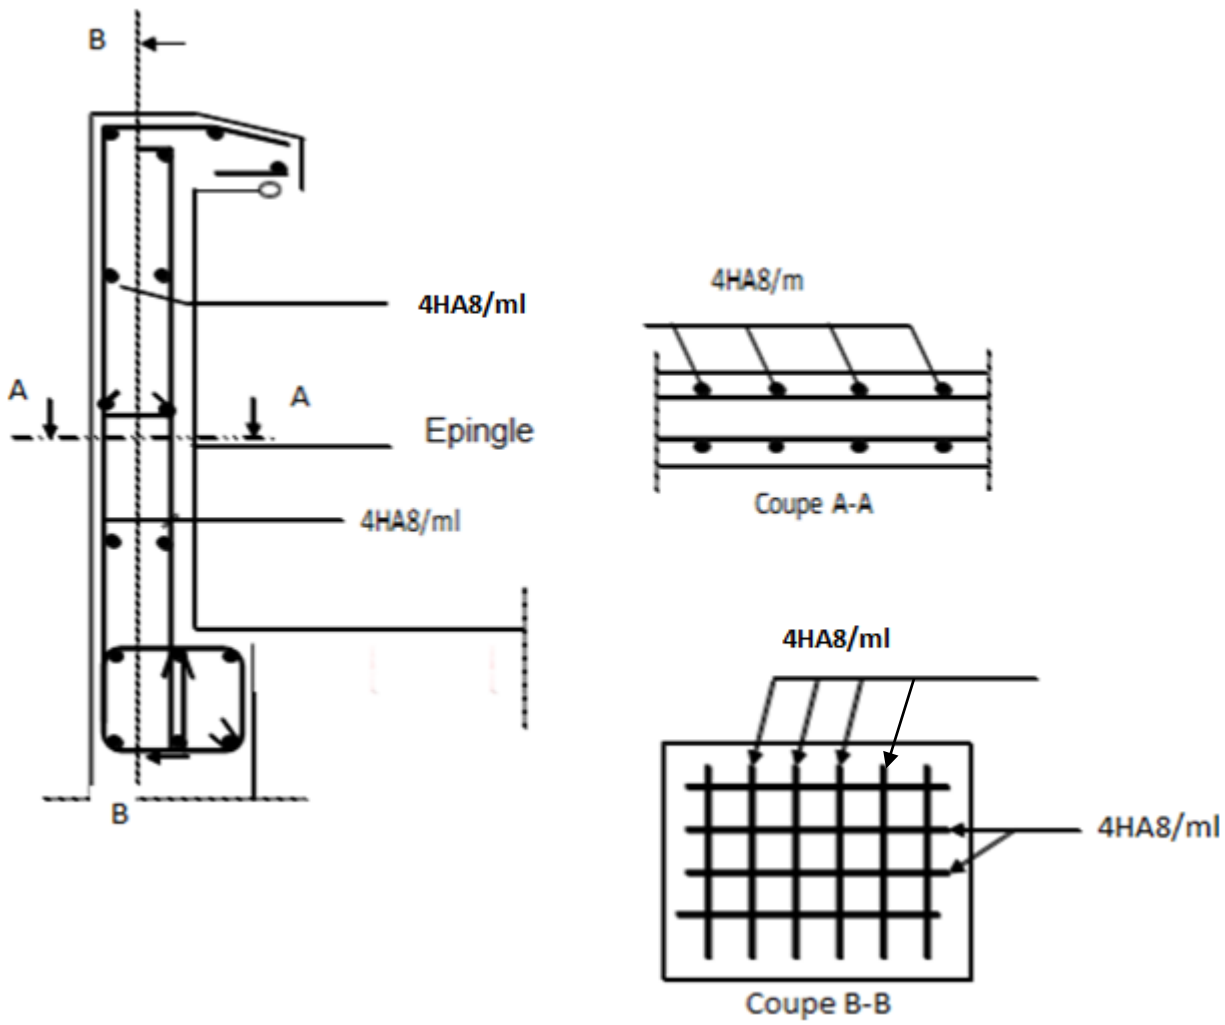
Schéma de Ferrailage de l'acrotère.
